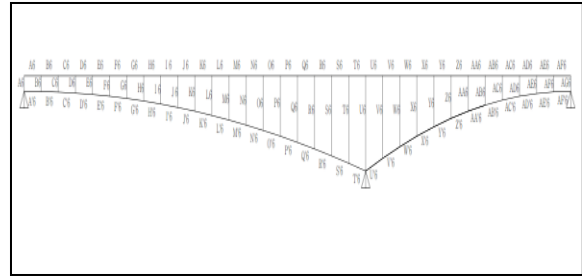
Gambar SAP2000 Tampak 3-d Extrude View
